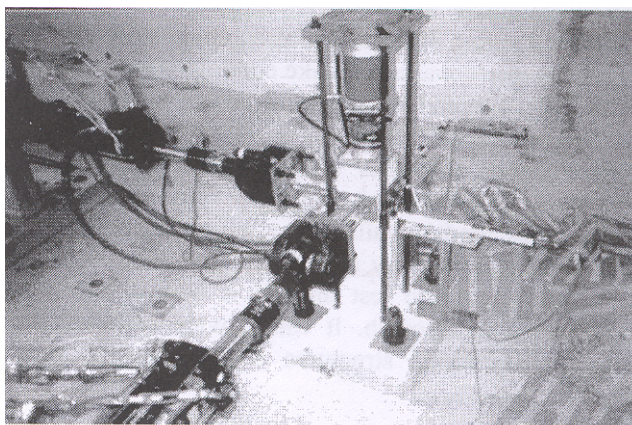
Setup de ensaio (Qiu et al., 2002).
